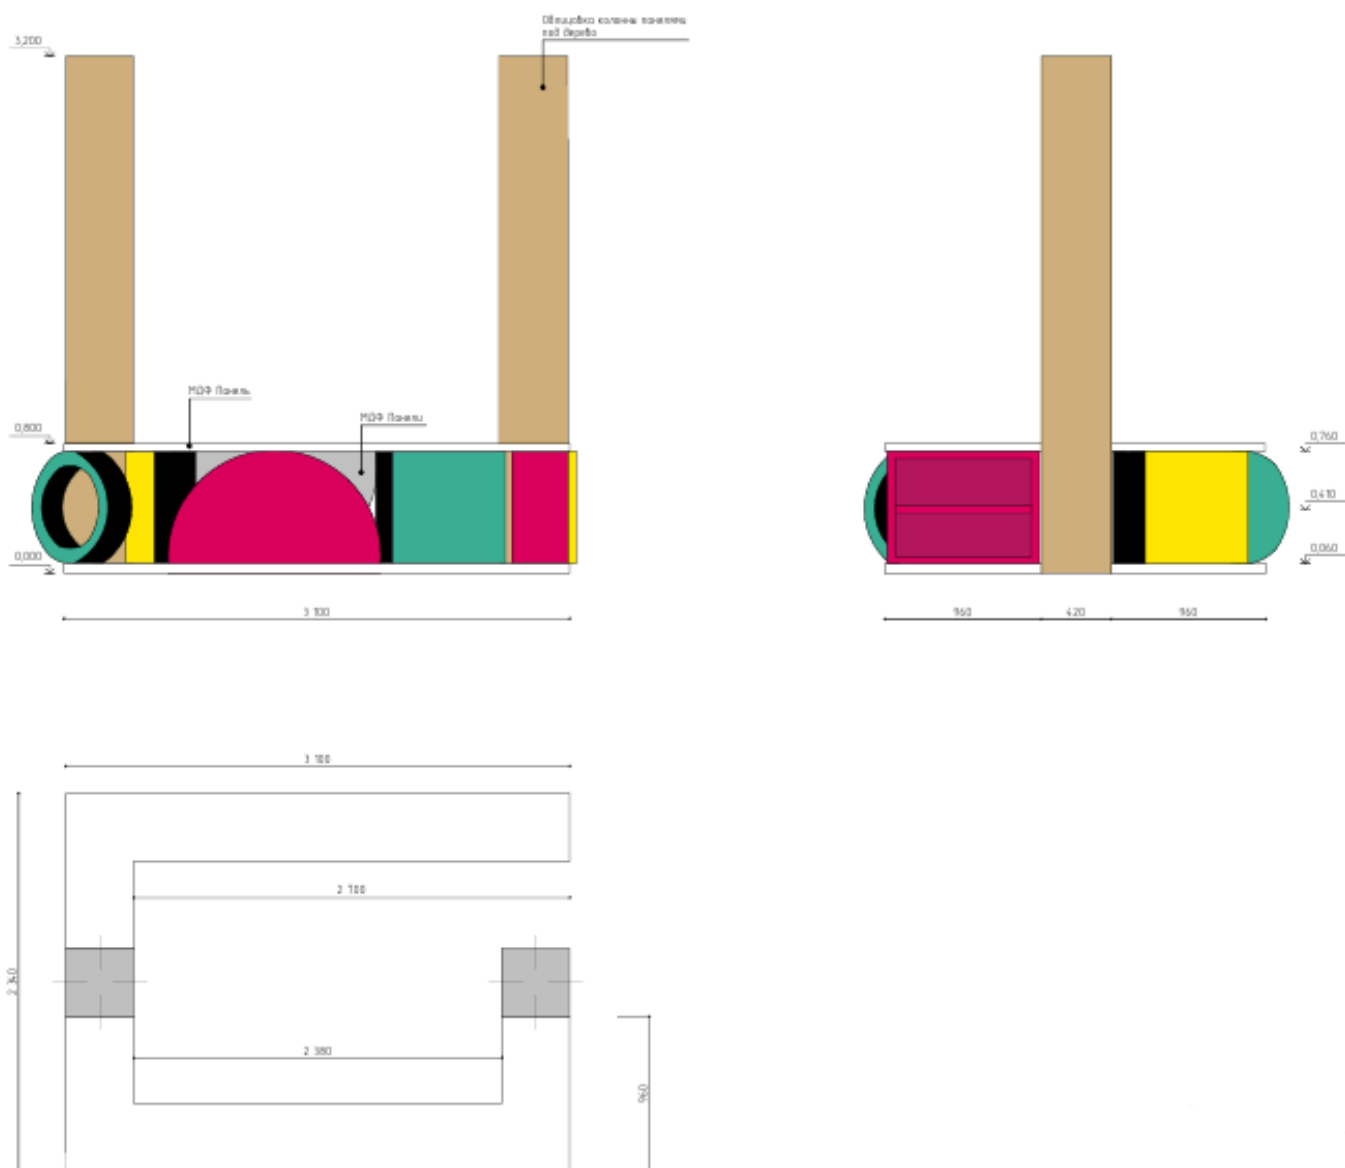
Чертеж стойки ресепшн в детской библиотеке, вид Б
